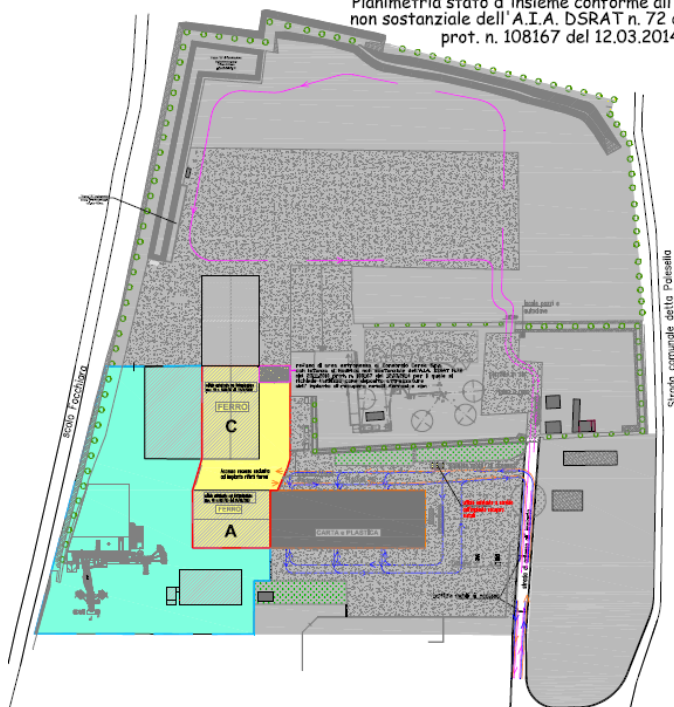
Planimetria dell'impianto con indicazione dei capannoni A e C
